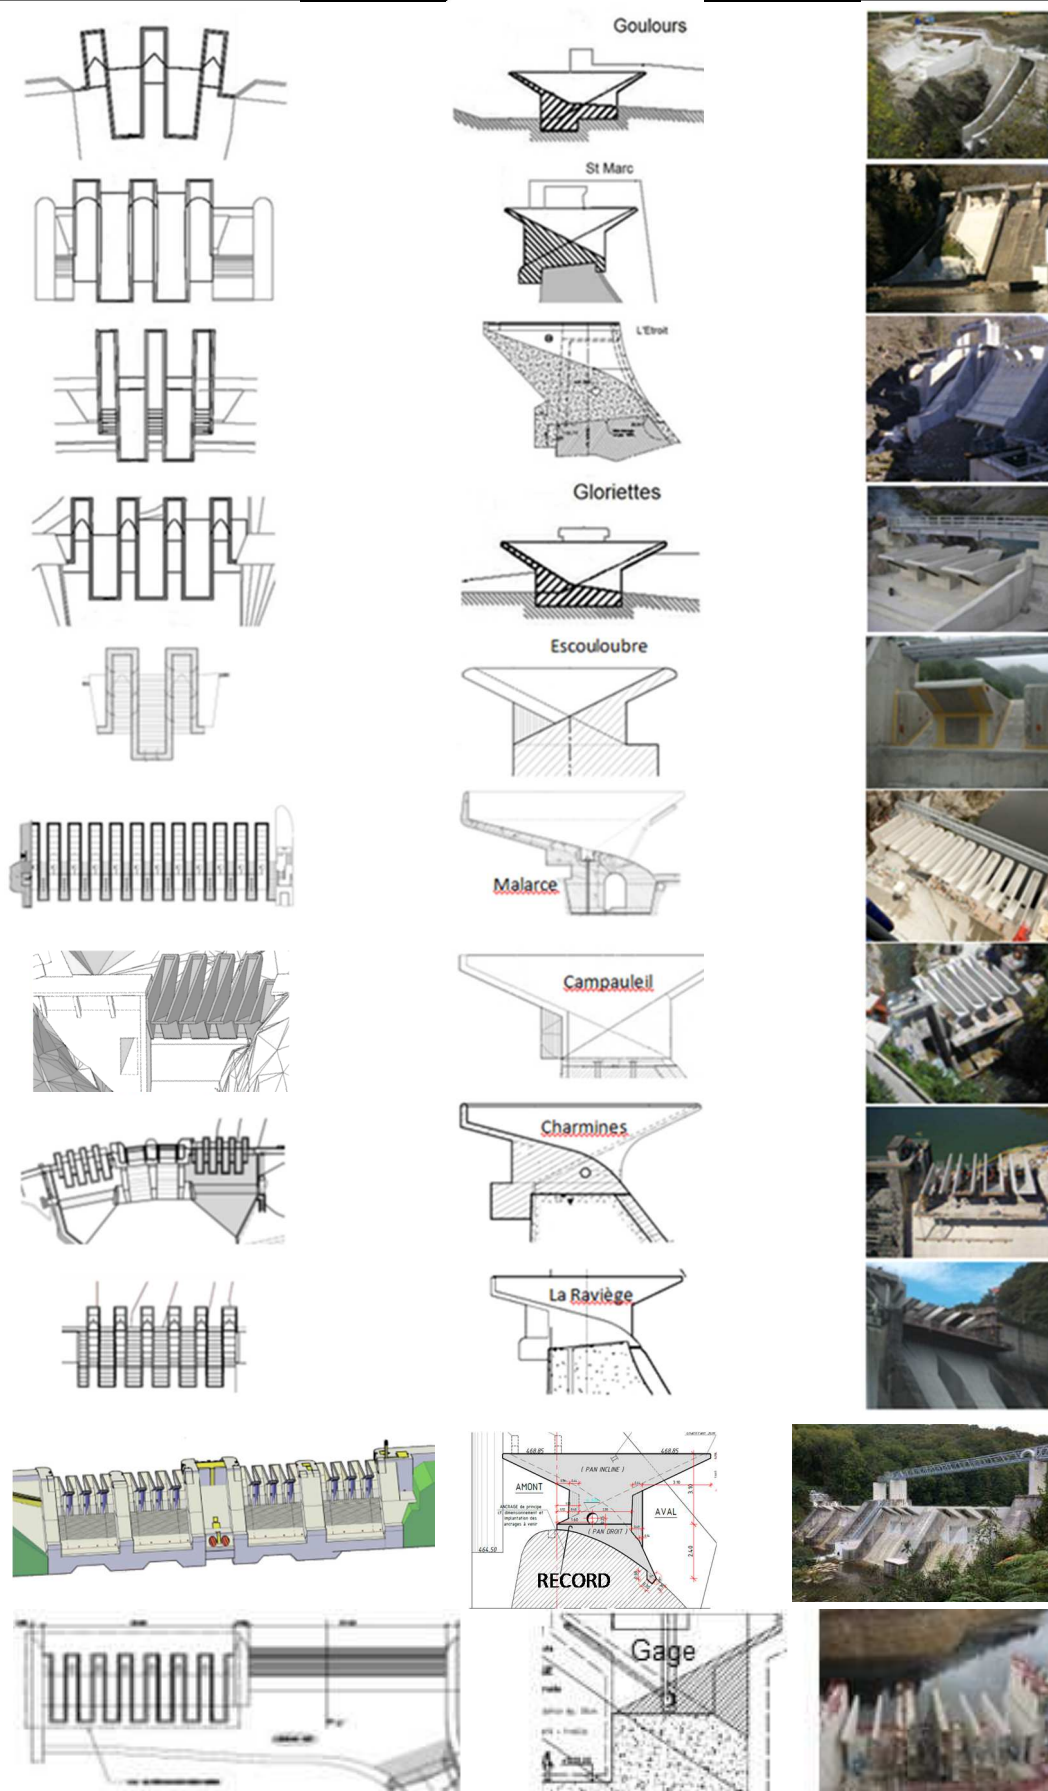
Vue en plan et coupe type des 11 PKW construits par EDF de 2006 à 2018
